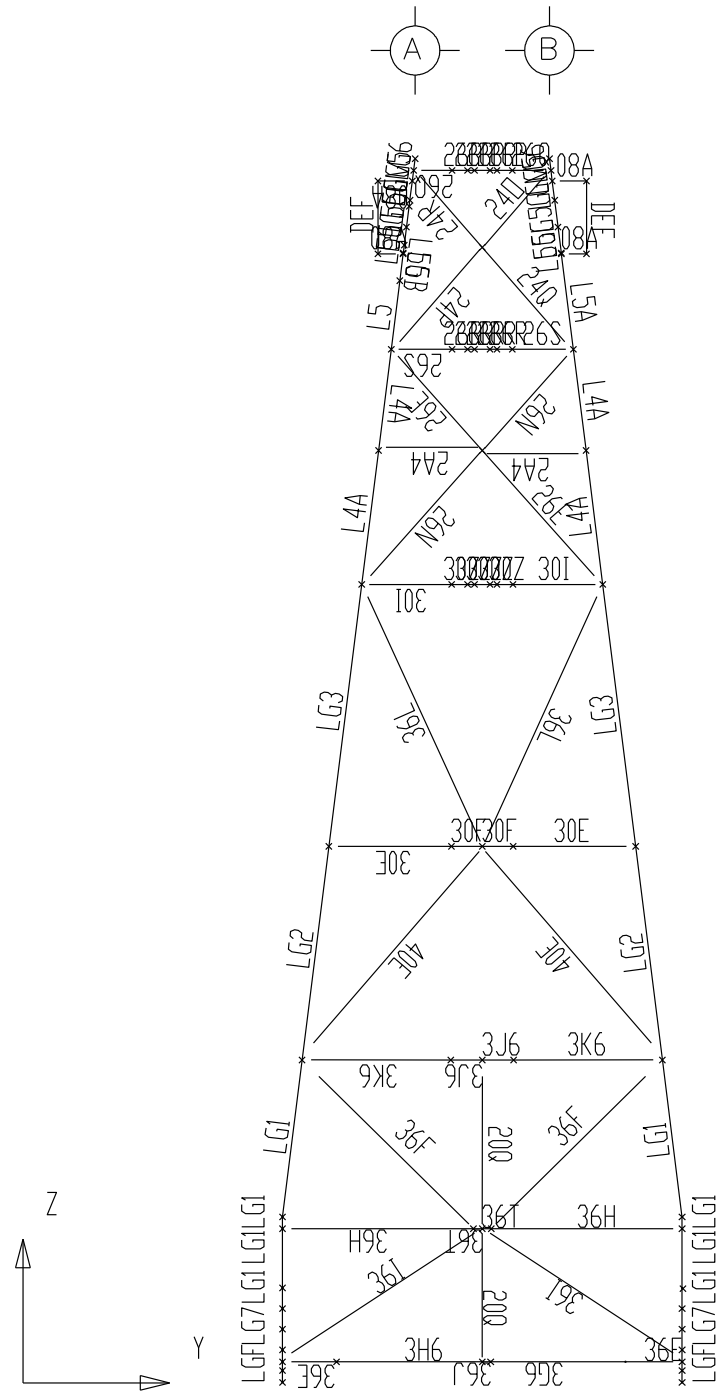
Grupos en marco transversal Eje 1, subestructura
